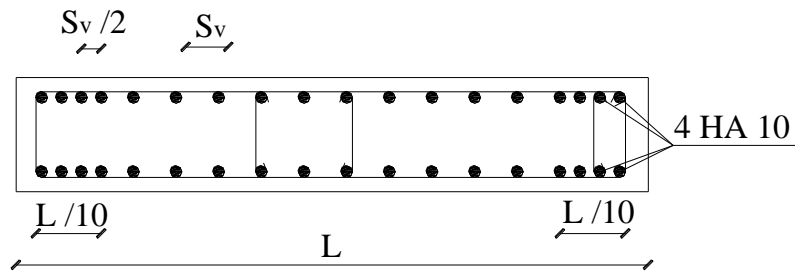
Schéma descriptif pour la disposition du ferrailage dans les voiles
